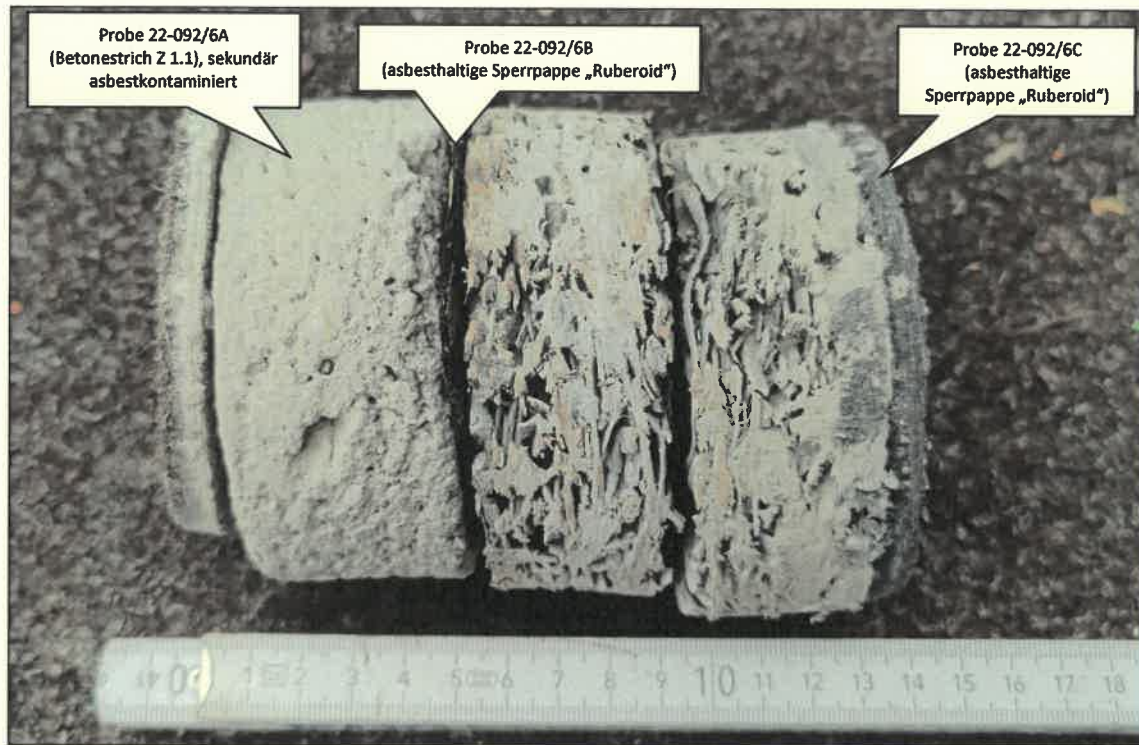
Anbau SE, Vorbereitungsraum R 112 – Kernbohrung 22-092/6 zeigt Fußbodenaufbau Fußbodenaufbau mit asbestkontaminiertem Betonestrich Z 1.1 über asbesthaltigen Sperrpappen „Ruberoid“, 2 Lagen HWL-Dämmung, Sperrpappe „Ruberoid“ und asbestkontaminiertem Rohbeton.
